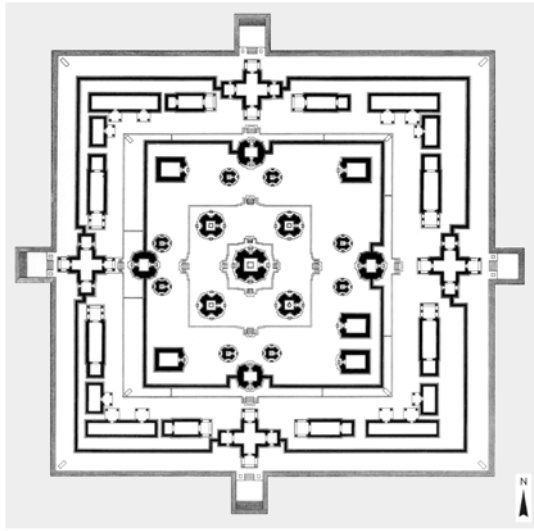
Grundriss Östlicher Mebon/Angkor
